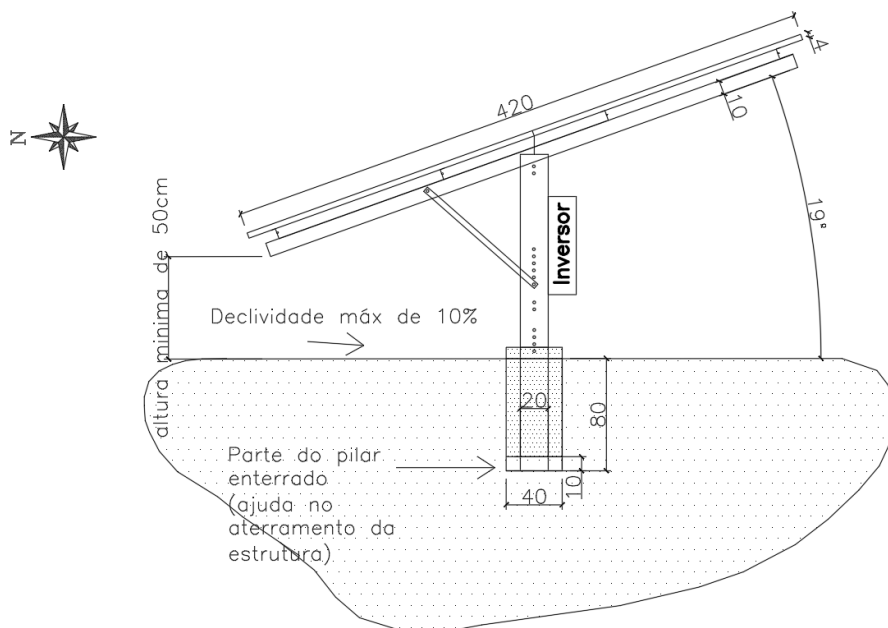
Desenho esquemático da base dos pilares da estrutura
